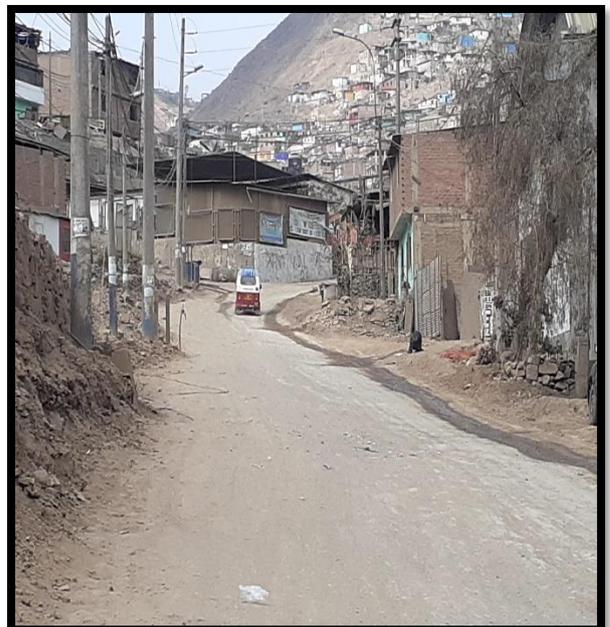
fotografías de las calles sin nombre en el A.H Santa María (Redes secundarias del sistema de alcantarillado)
